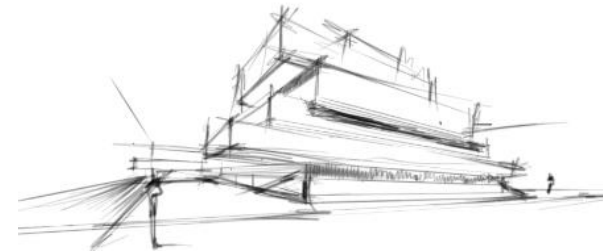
Sketch Articulación constructiva.⁶⁴
